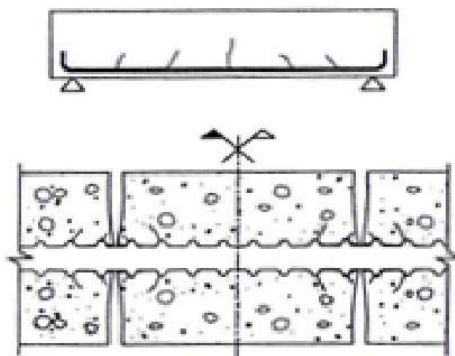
Fisuras producto de la imposibilidad del hormigón de seguir la deformación del acero (CALAVERA, 2005)
